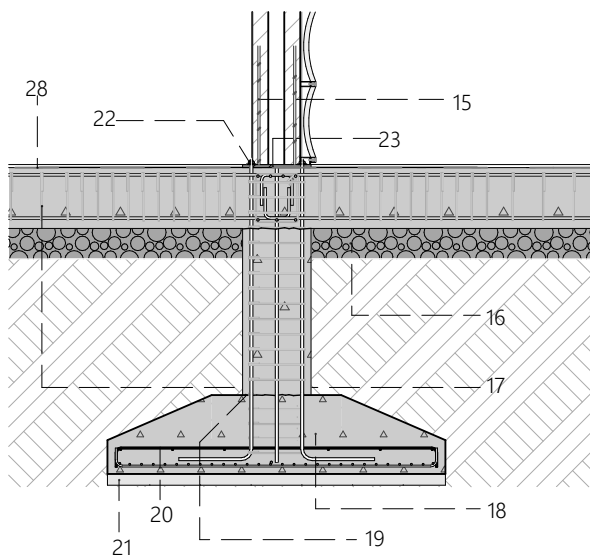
Sección constructiva 2. Elaboración: Autor.
